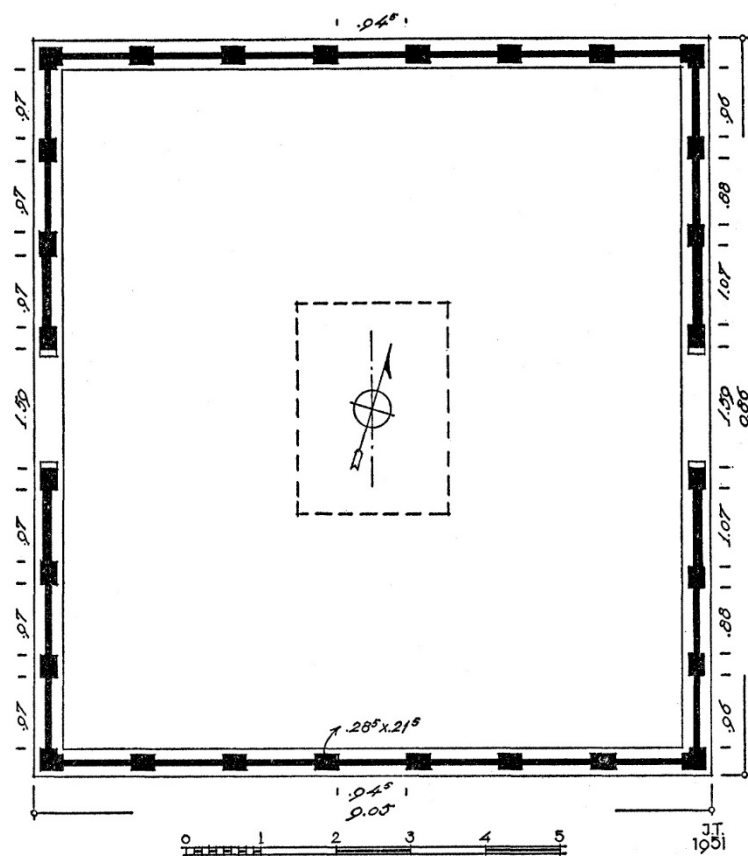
Pianta del parapetto di II Fase (Thompson 1952)
